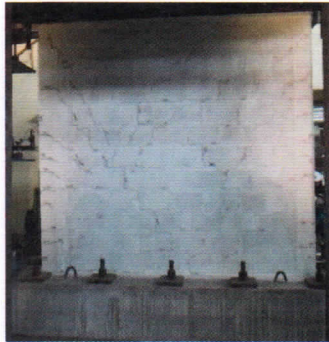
Continuación de grietas diagonales en la parte inferior del muro para una distorsión 1/800 Vista cara Sur.
